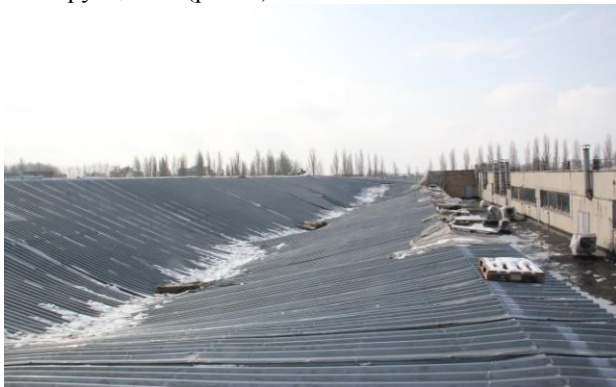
Проседание кровельного покрытия совместно с несущими конструкциями / Sinking roofing together with bearing structures
